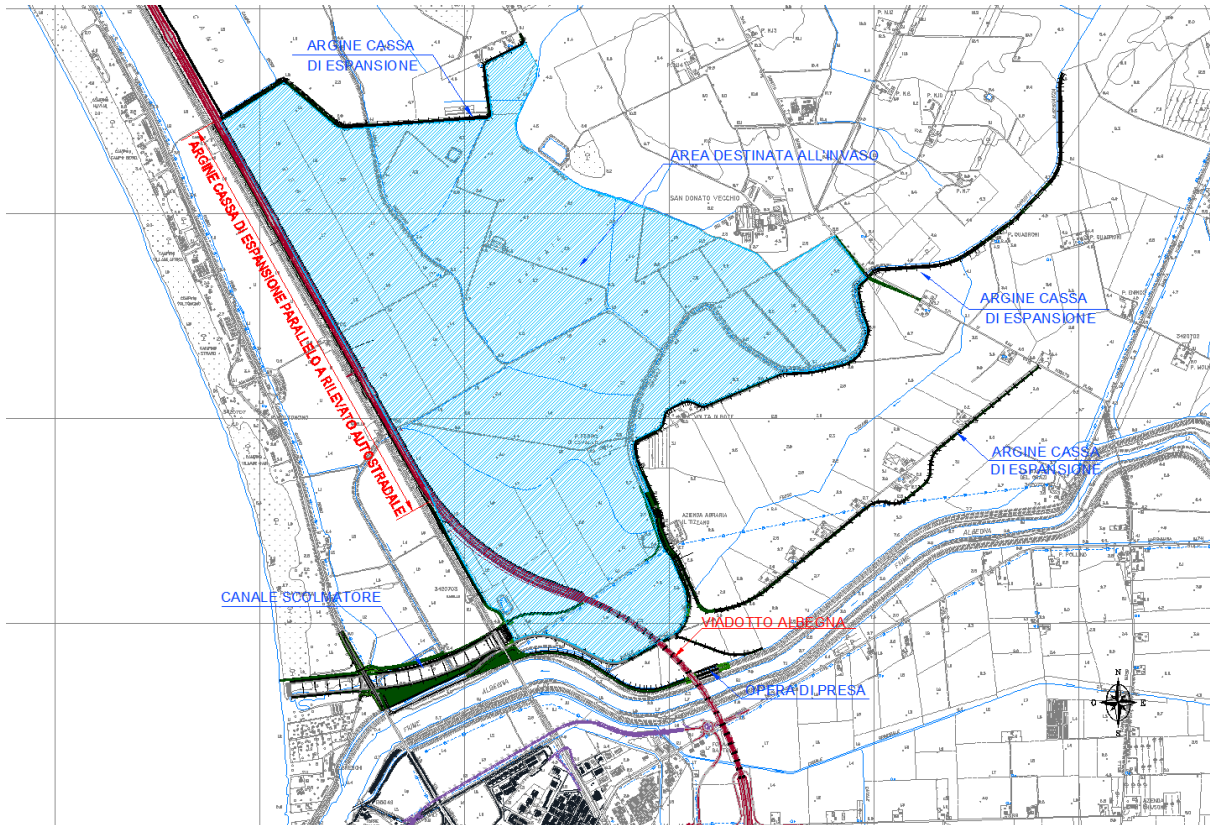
Planimetria area cassa di espansione Campo Regio
